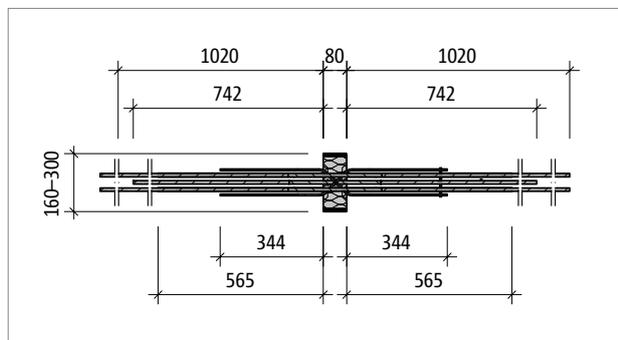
Schöck Isokorb® T Typ WL-M4: Produktgrundriss
